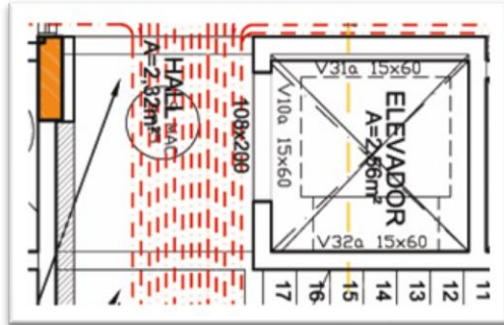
Planta baixa intersecção de dutos com vigas.
